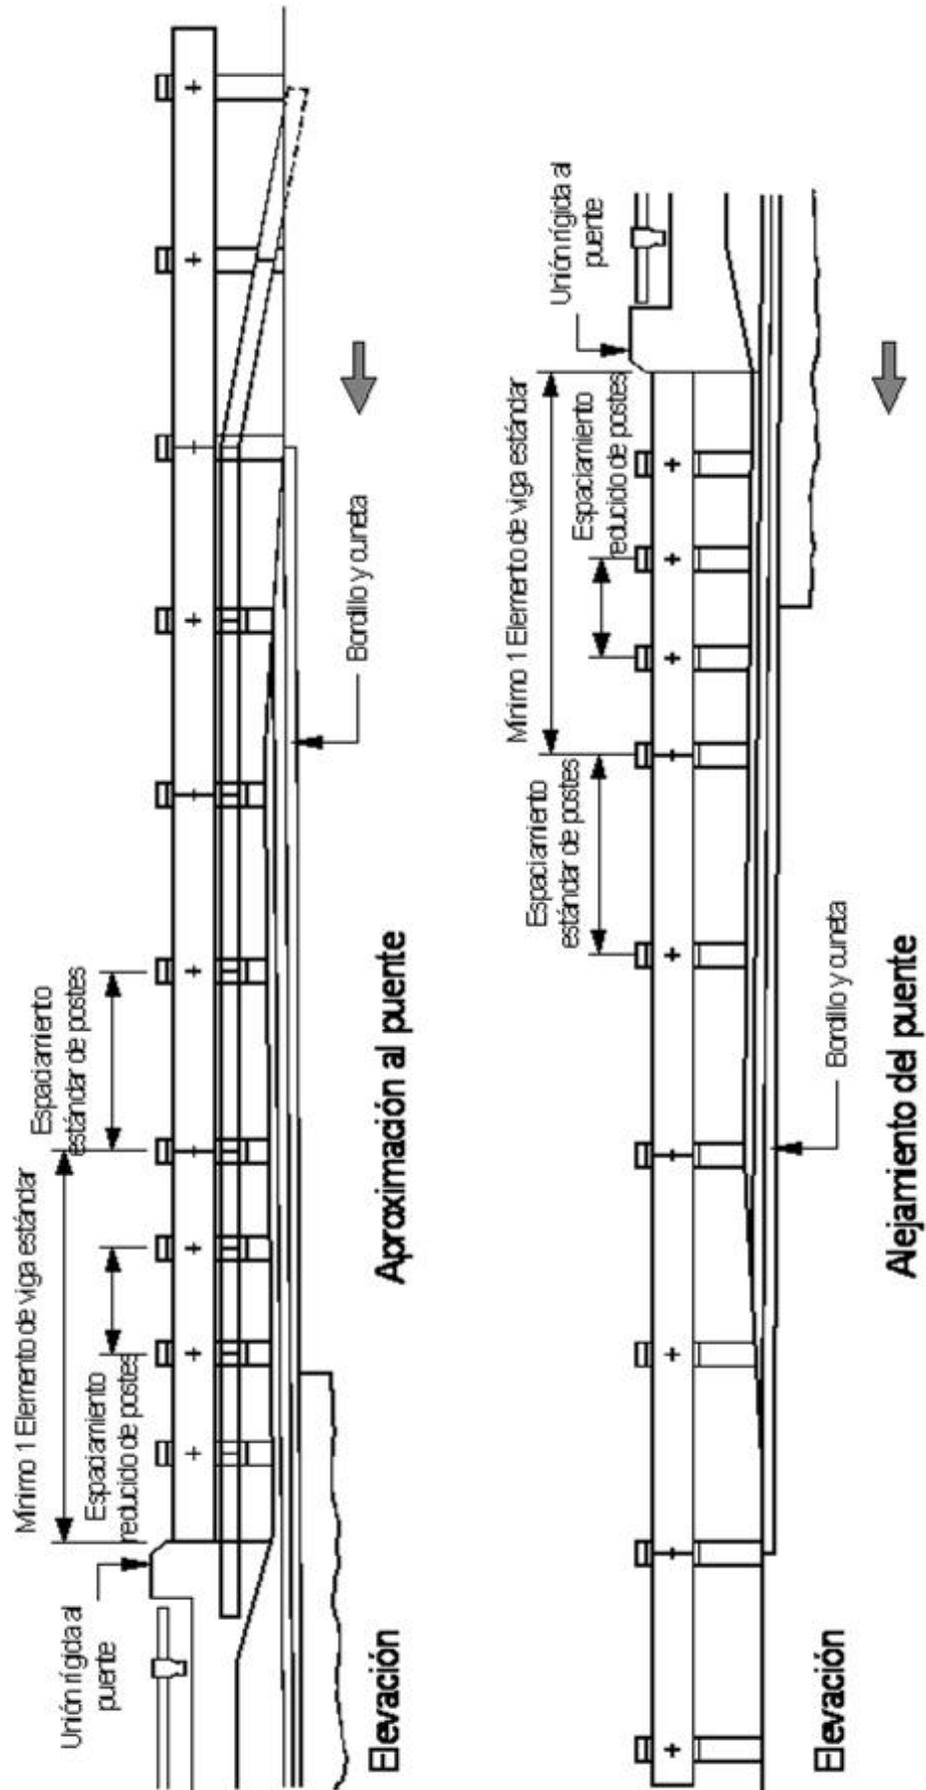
BARRERA DE VIGA DE ACERO EN LOS EXTREMOS DE UN PUENTE
